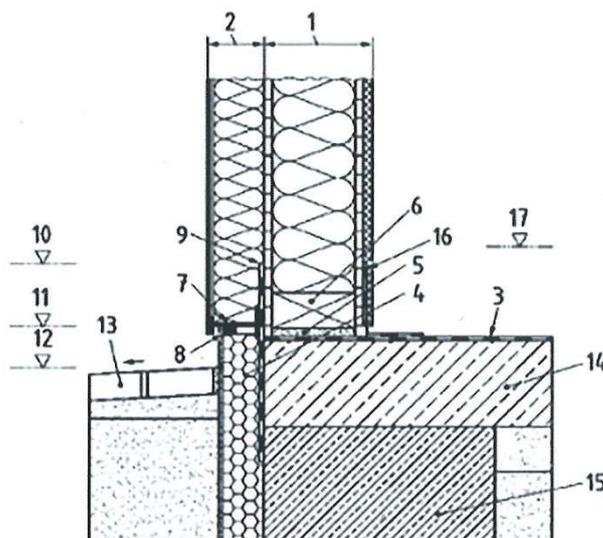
Parete meno distanziata dalla fondazione con letto di ghiaia sulla facciata esterna
